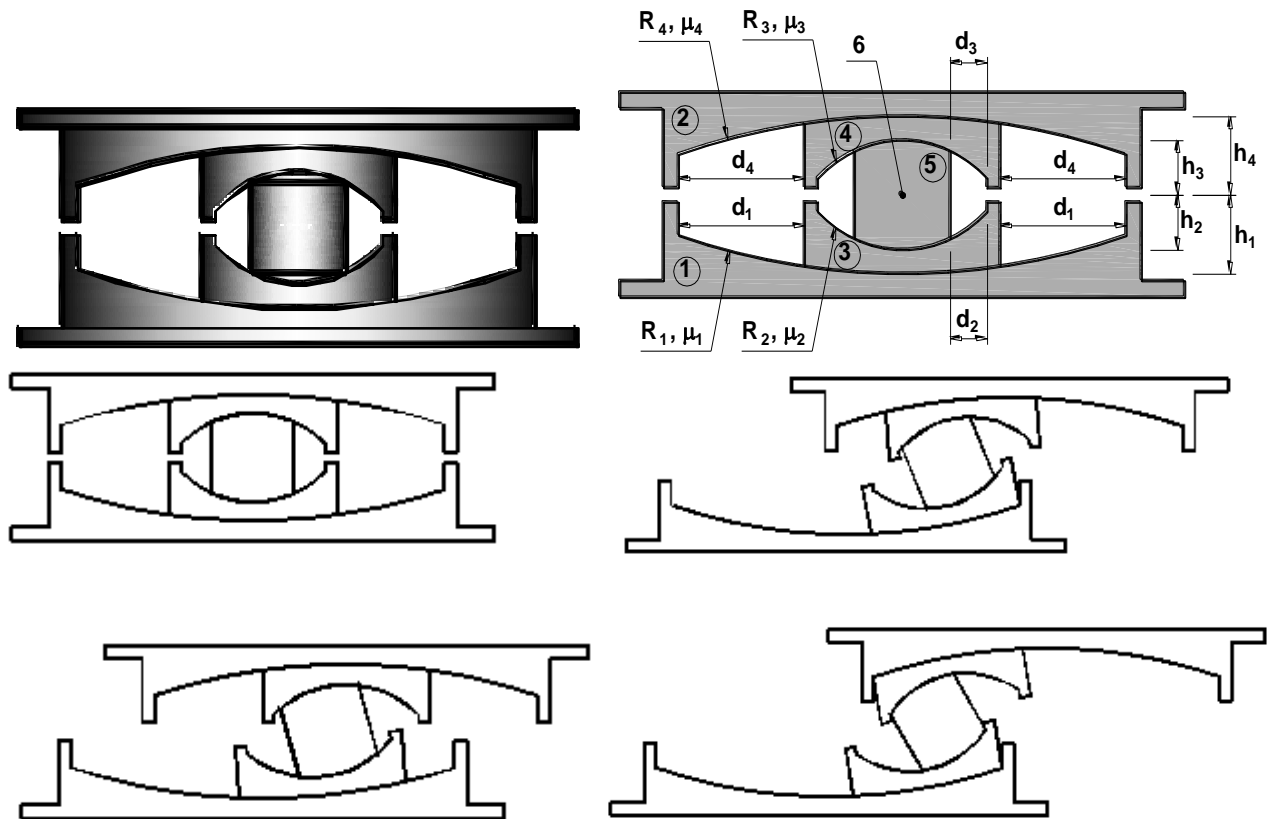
Общий вид и схема поведения трехмаятниковой опоры:
